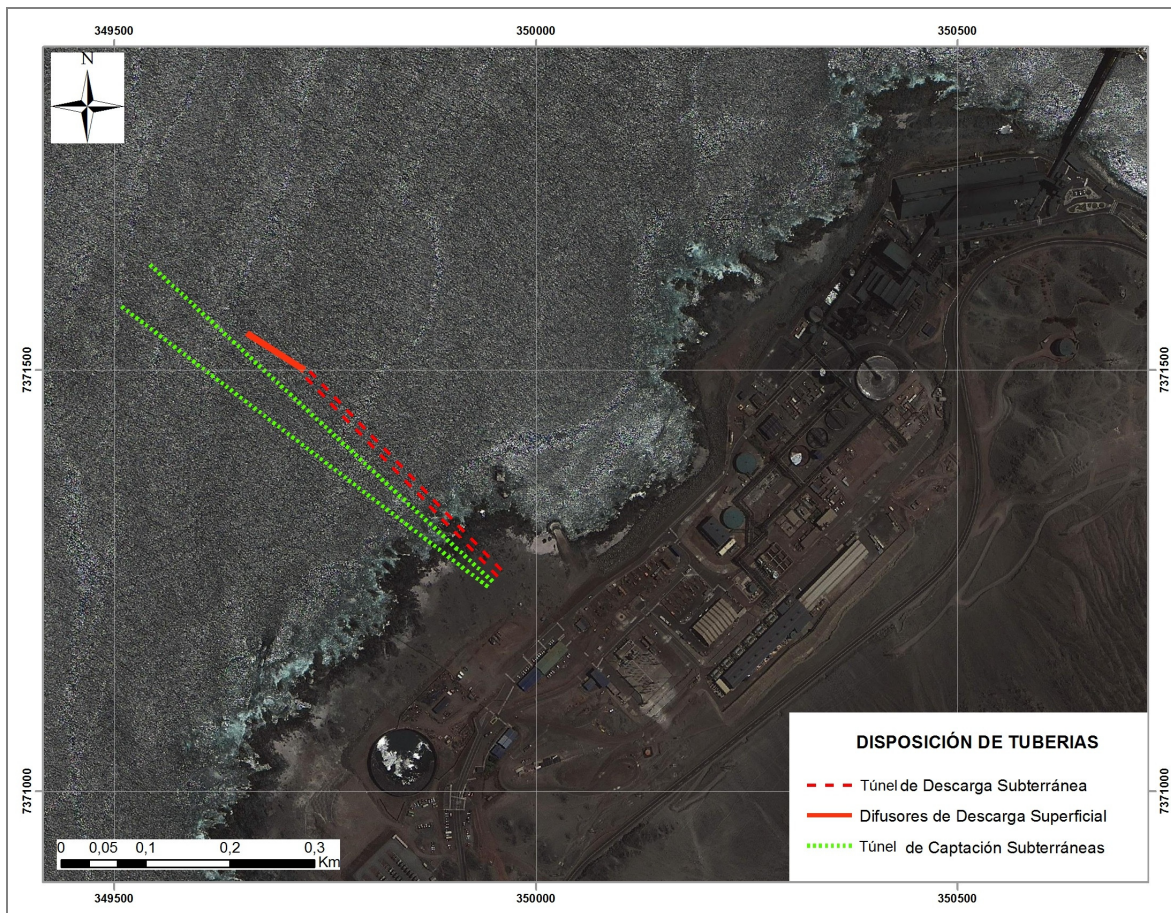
Modificación Disposición en Planta de Túneles de Captación.
